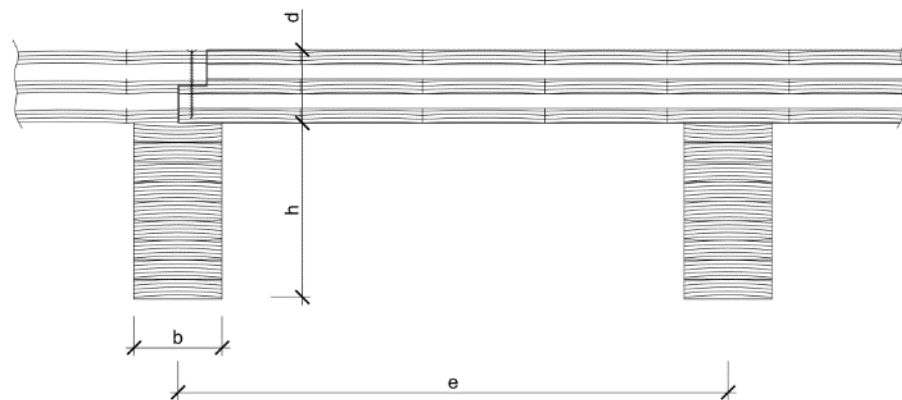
Rippenplattendecke mit Falzbrett ¹³⁹
